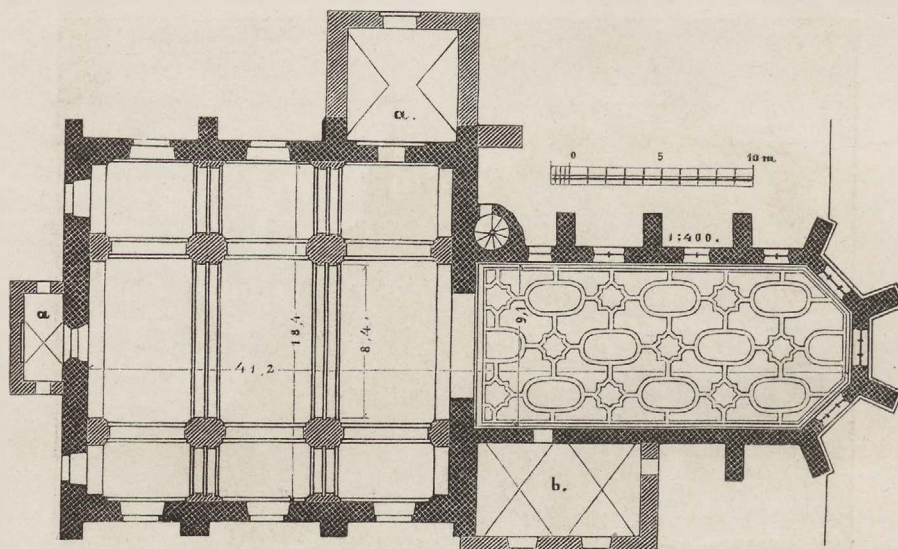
Neuenburg. Grundriss der evangel. Kirche.
